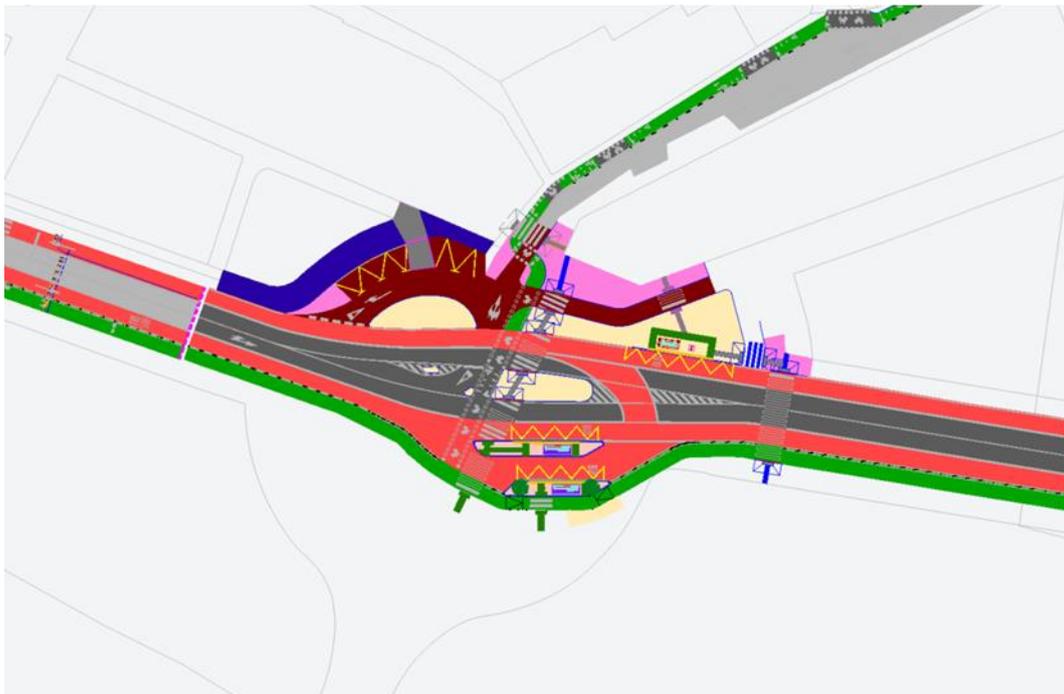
Detalle de la solución en Plaza Cruz Roja (lote 3 – lote 3).
